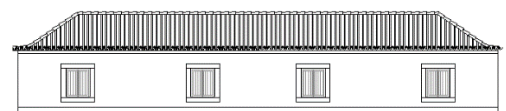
“Alçado Sul e Norte – Armazéns.”
